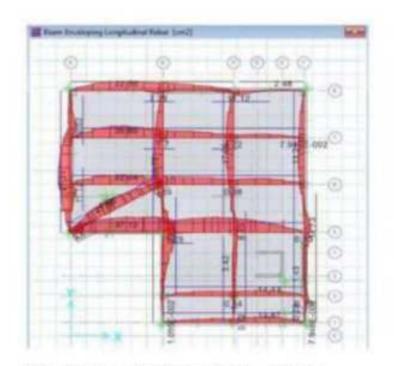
Area de acero de refuerzo en vigas de cimentación.
